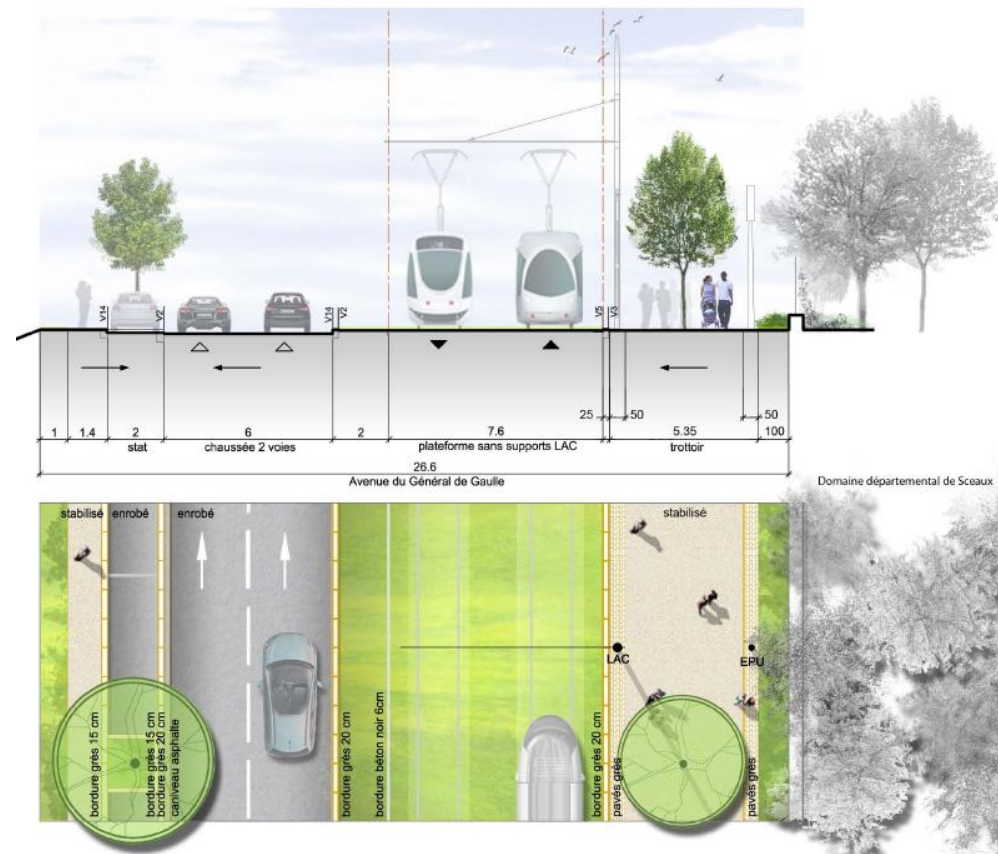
Le long du parc - coupe S4b et plan d'ambiance
